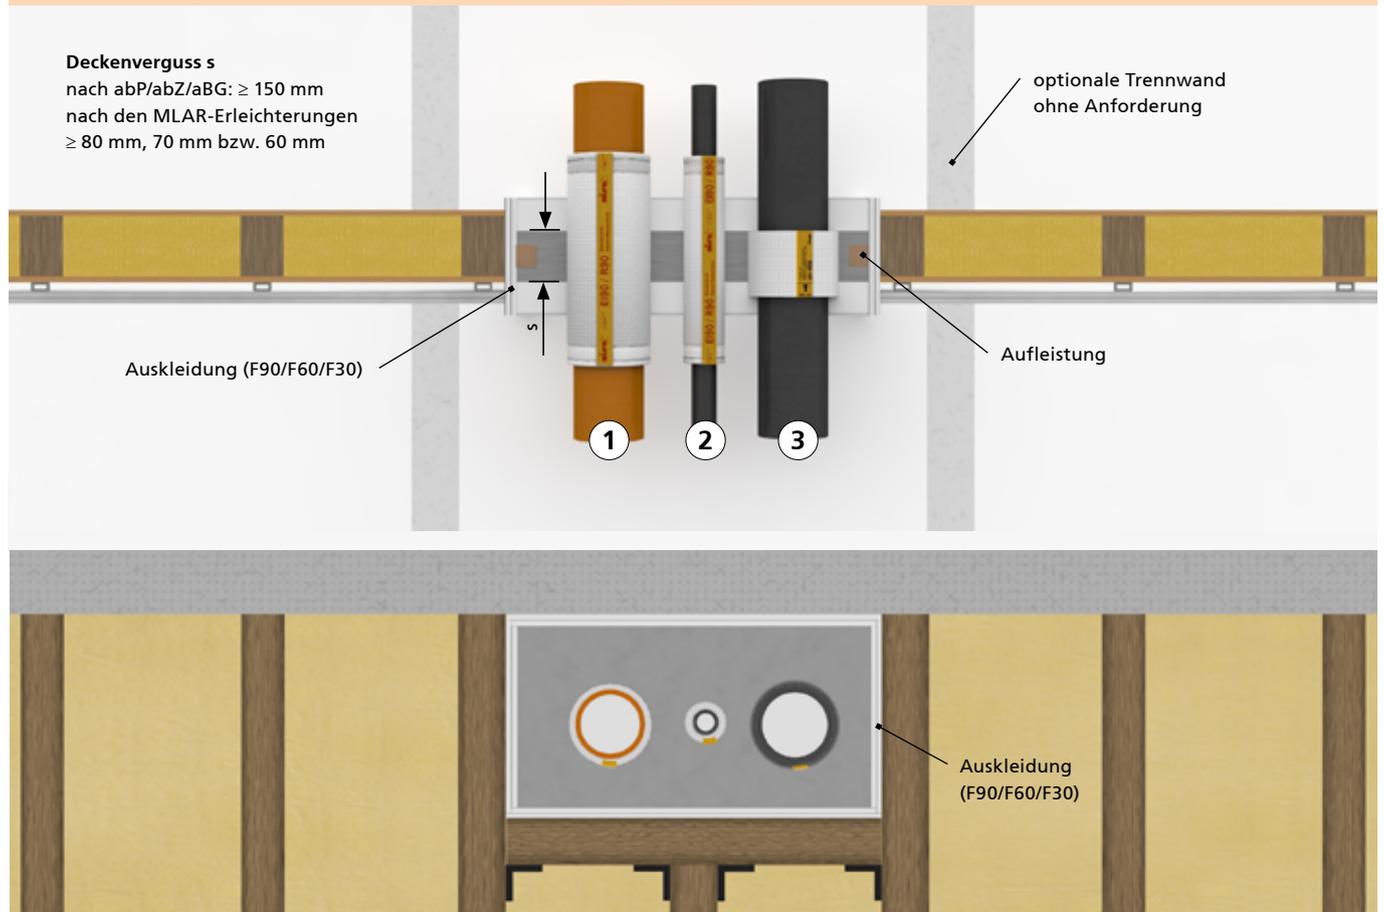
Durchführung von nicht brennbaren und brennbaren Rohrleitungen Sanitär/Heizung durch Holzbalkendecken mit F90-, F60-, F30-Deckenverguss
